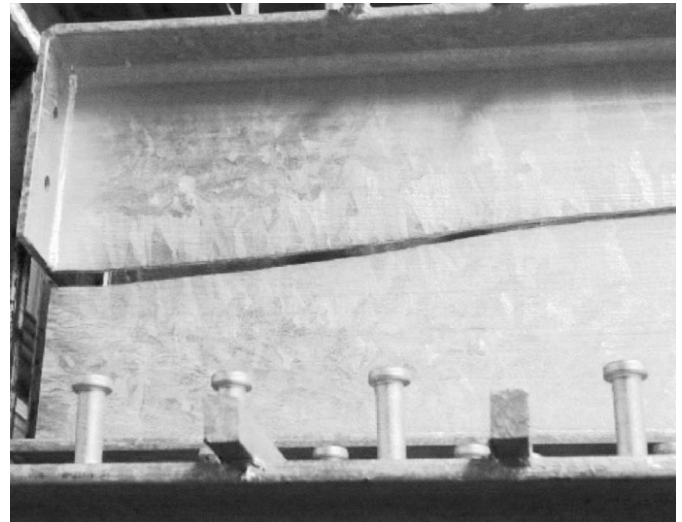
Riß im feuerverzinkten Stahlträger im Verbunddeckenbau mit angeschweißter Teilkopfplatte
